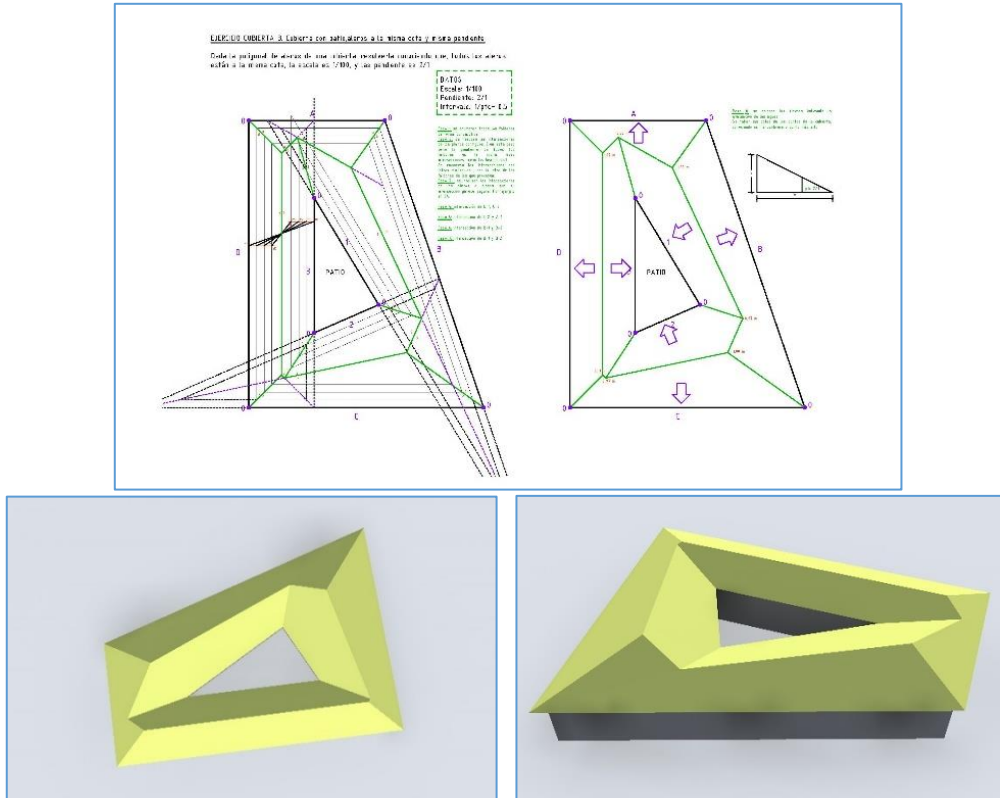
Ejercicio de Sistema de Planos Acotados aplicado a cubiertas y representación 3D mediante DAO
